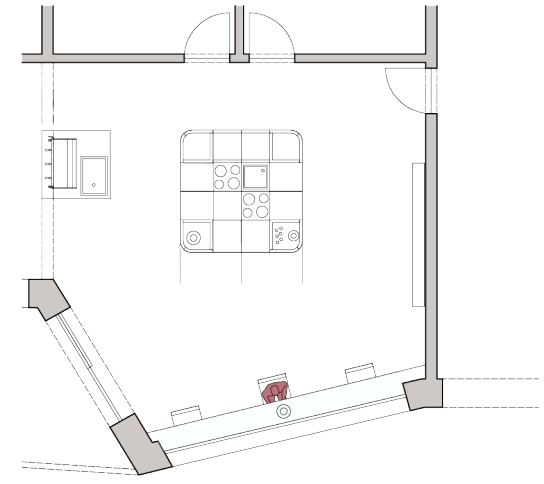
Grundriss - Situativer Miniküchen-Cube
